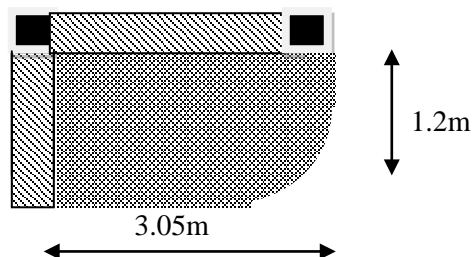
Schéma de ferrailage de la dalle sur 3 appuis.
